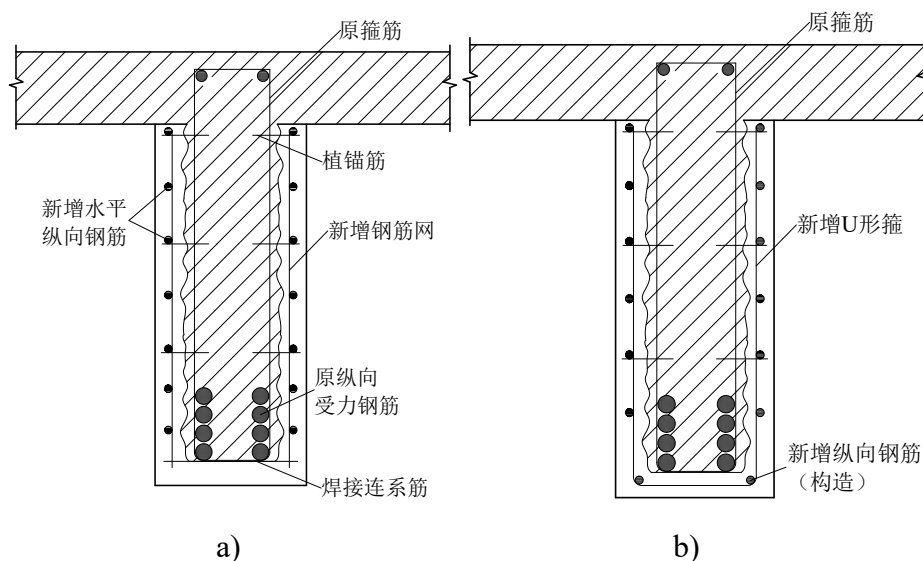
受弯构件新增抗剪钢筋连接构造示意图
